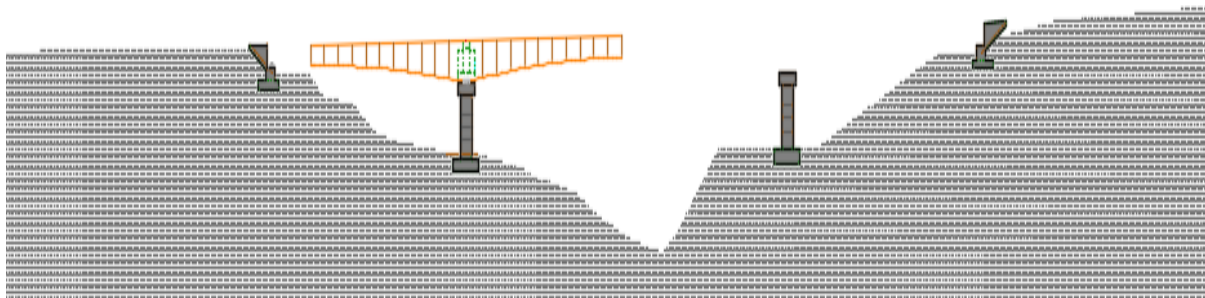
Disposition des voussoirs à partir de la pile P1
